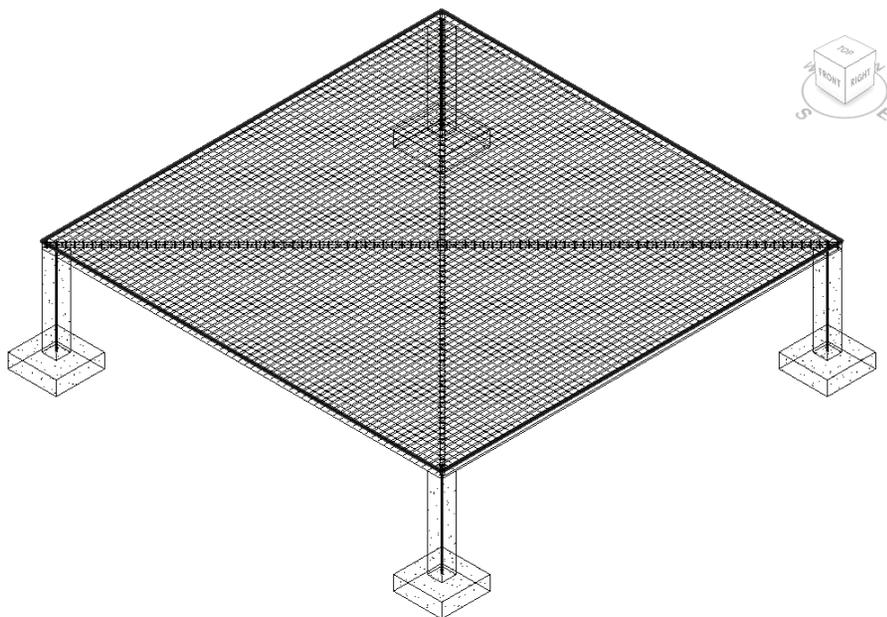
Схема фактического армирования плиты перекрытия 12×12 м
